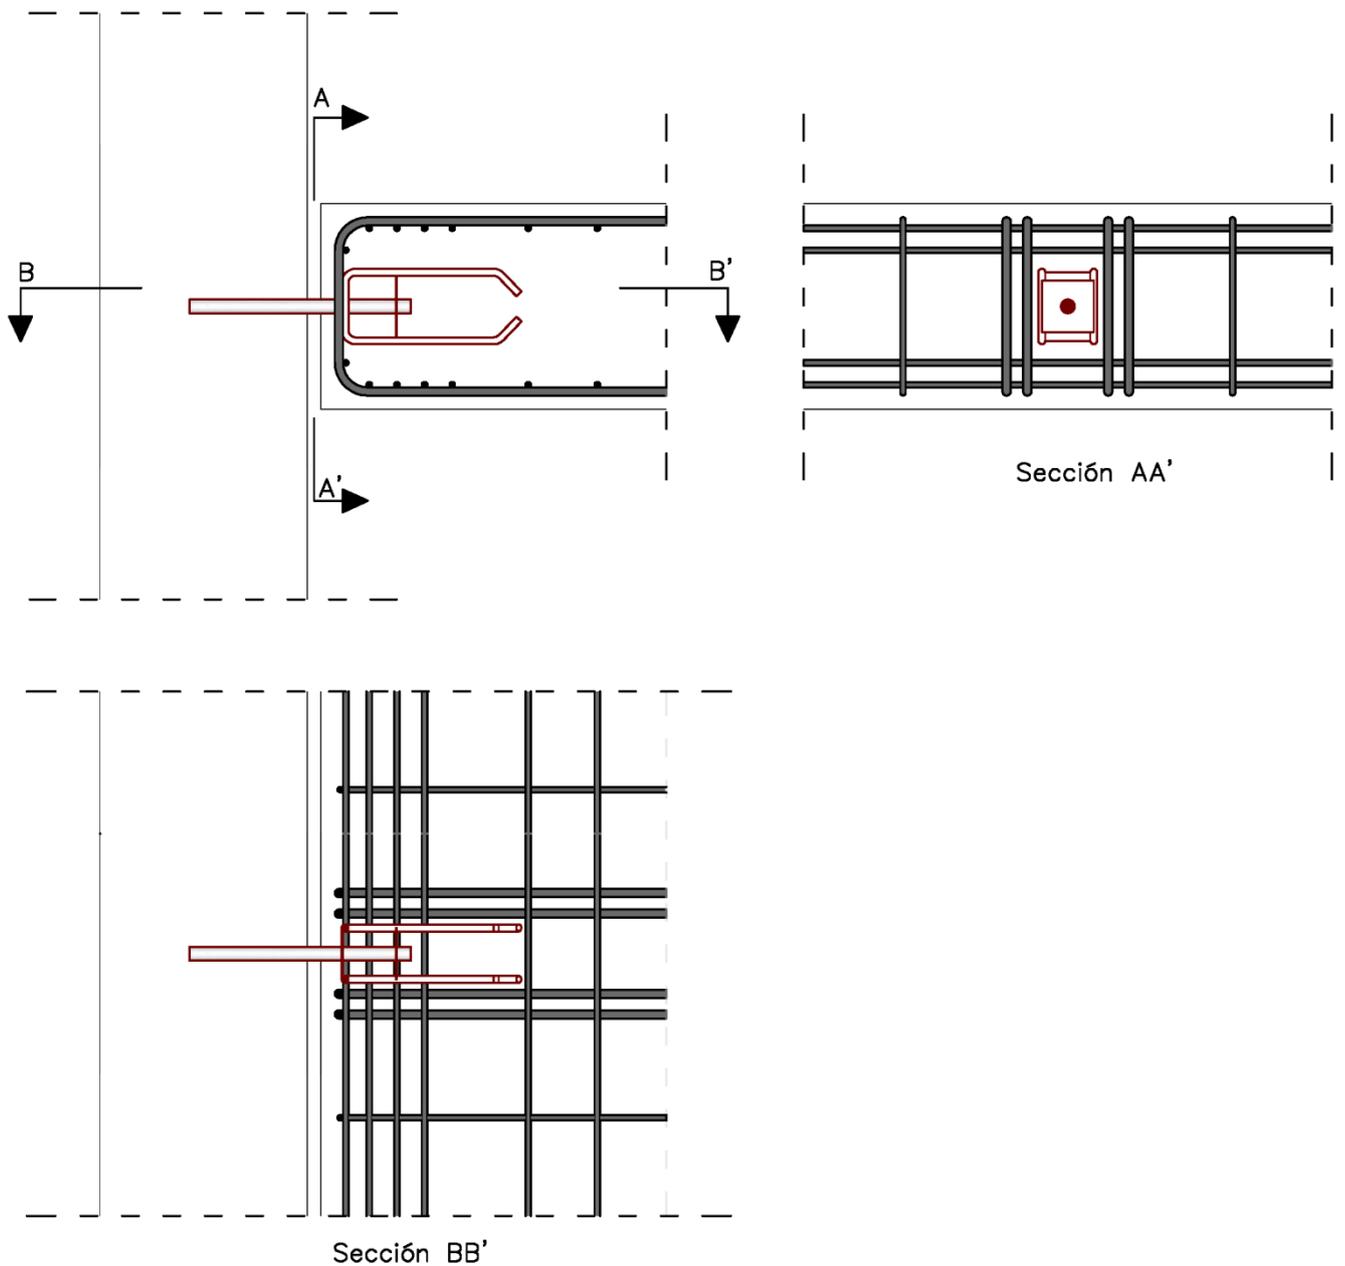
Disposición de armaduras de suspensión y viga de borde alrededor del conector Geoconnect® MP.
